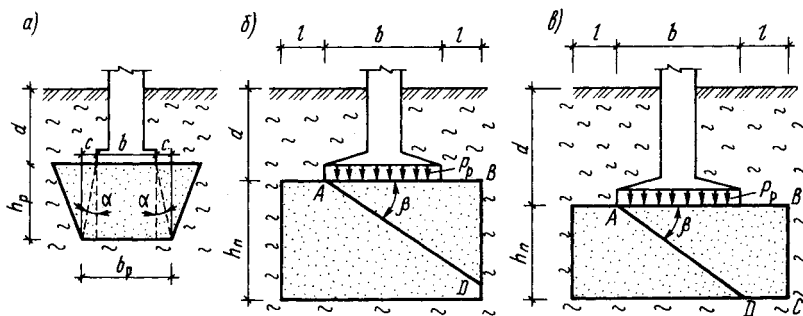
Расчетные схемы фундаментов на песчаных подушках, заменяющих слабые грунты
